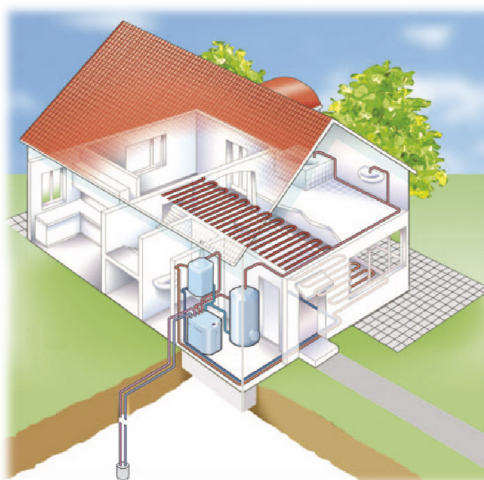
Tepelné čerpadlo zemní kolektor - voda
